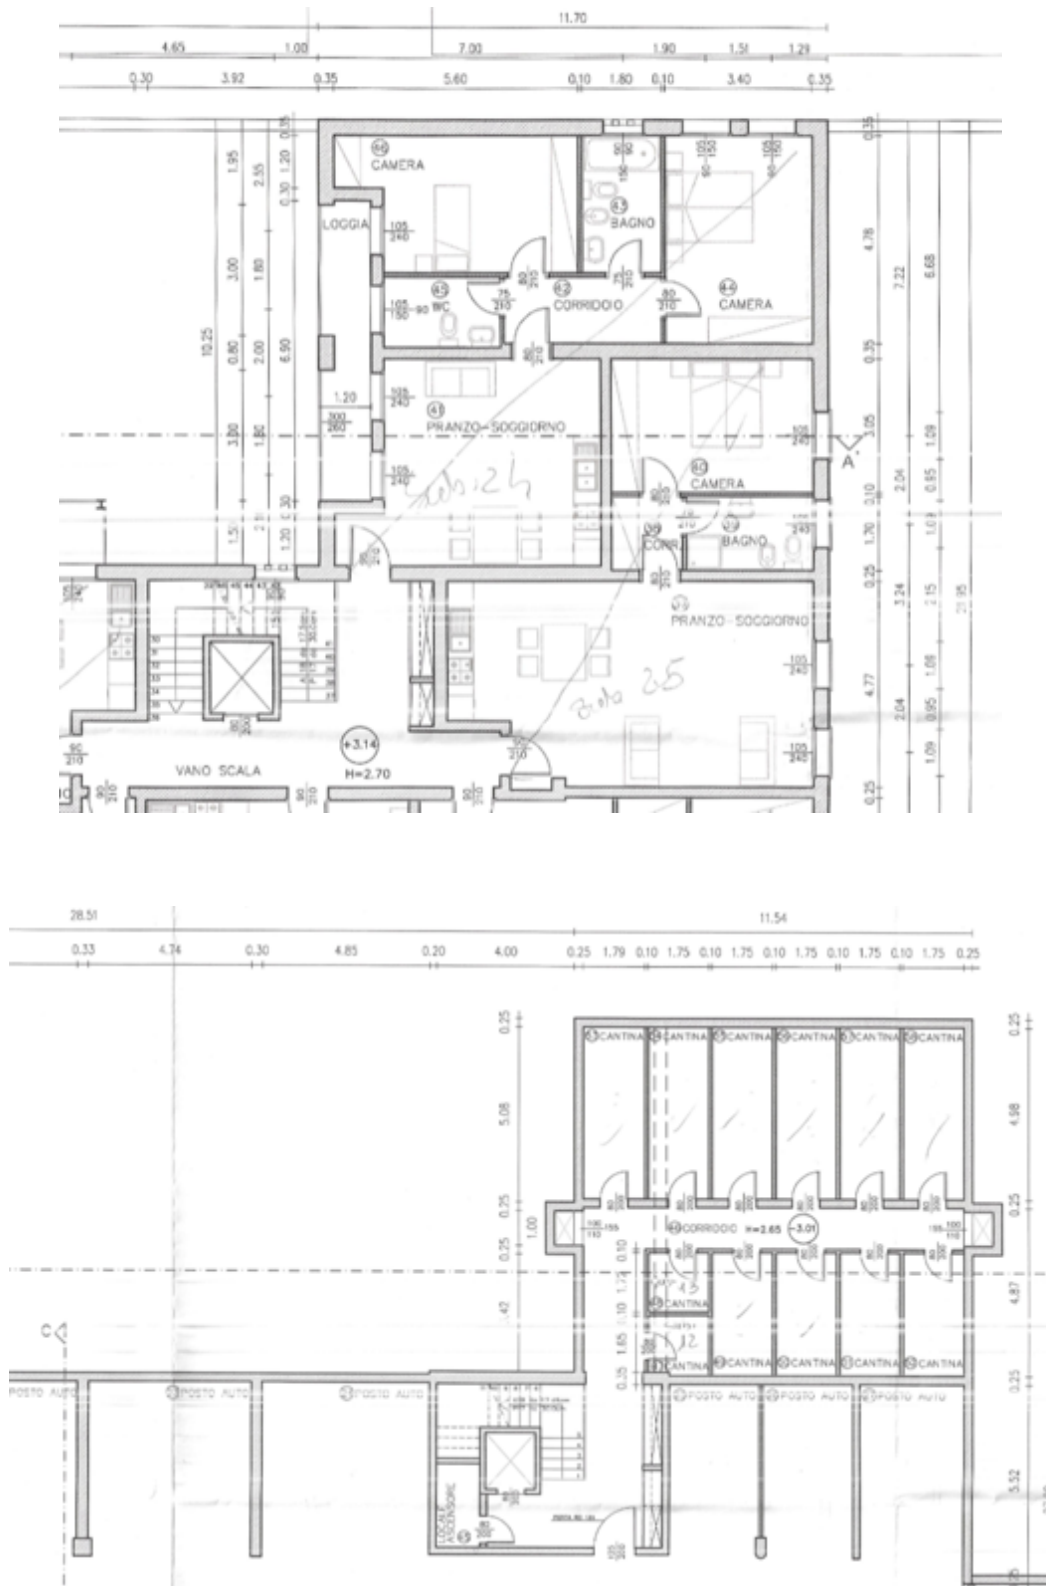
Piano Primo e Piano Interrato _ stato autorizzato.
